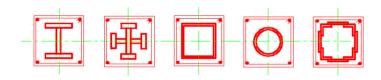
型钢混凝土柱的型钢截面配筋形式
